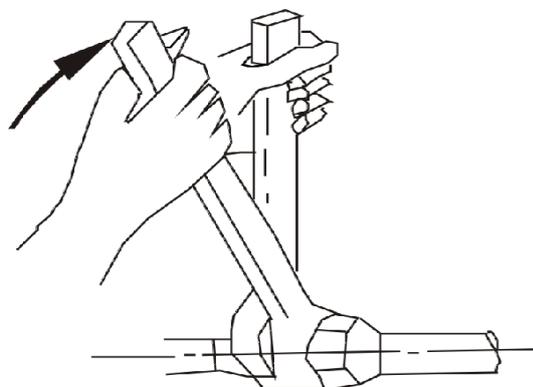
Принципиальная схема прокладки водопроводной трубы
